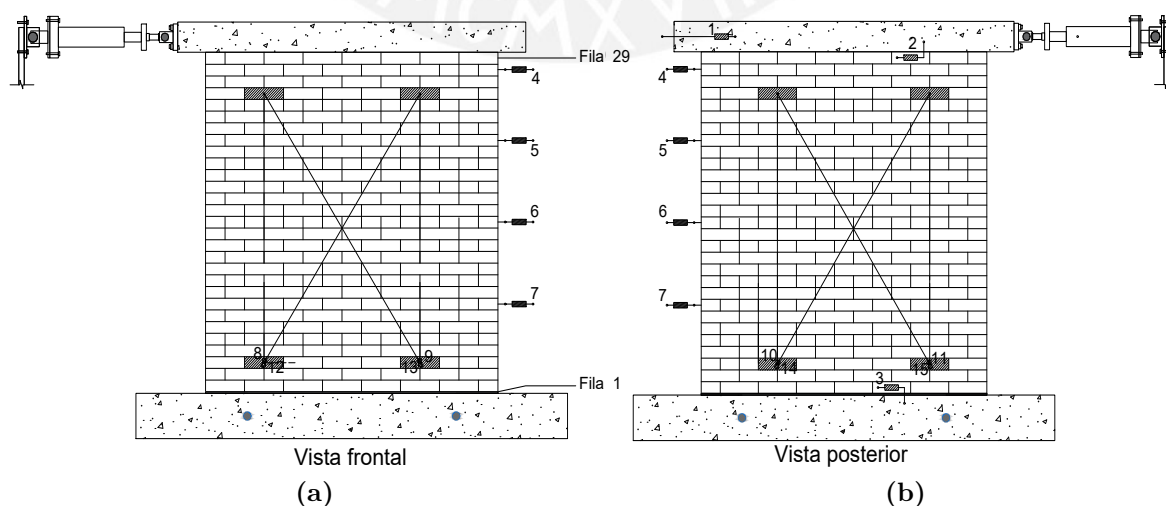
Instrumentación y colocación de los LVDTs en los muros.
